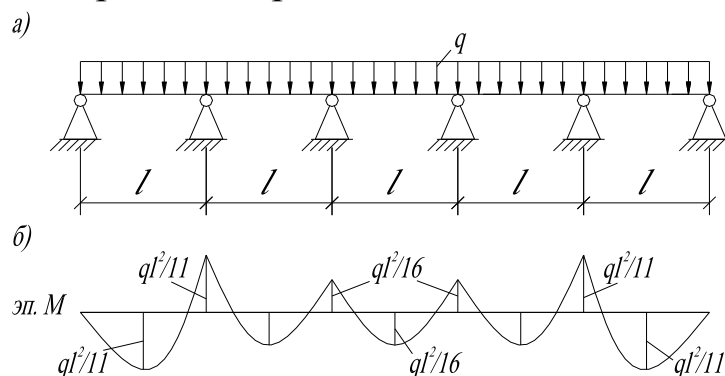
Расчетная схема (а) и эпюра моментов монолитной плиты (б)
